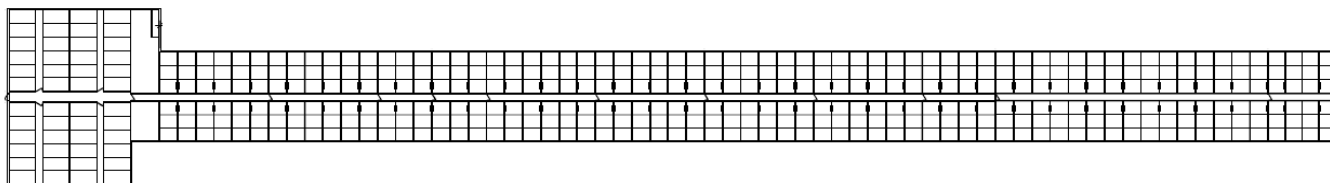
Plan de l'engraissement construit en 1998 du site naisseur-finiisseur de 250 truies
